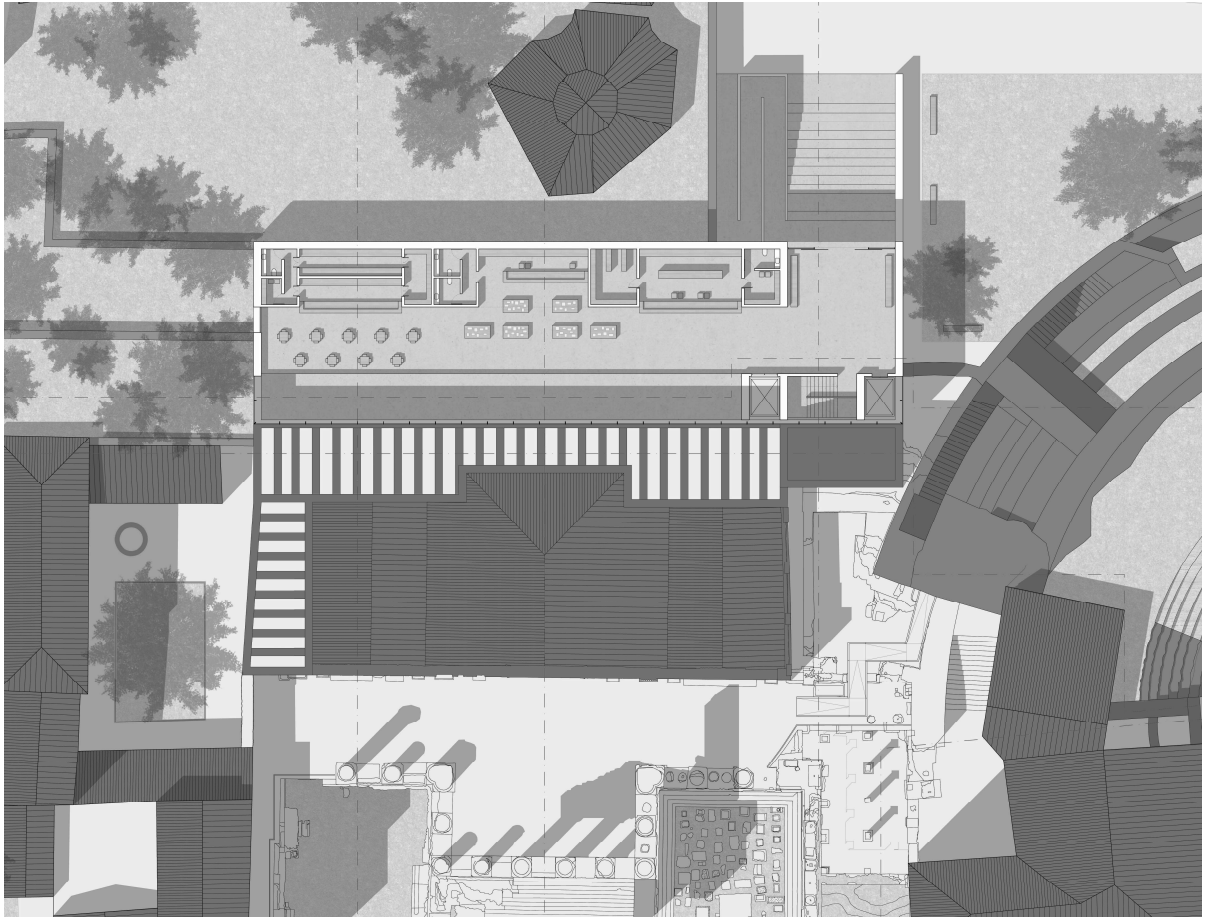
Pianta dell’edificio di progetto posto alle spalle del Capitolium alla quota d’ingresso, ultimo piano dell’edificio, piano terzo.
